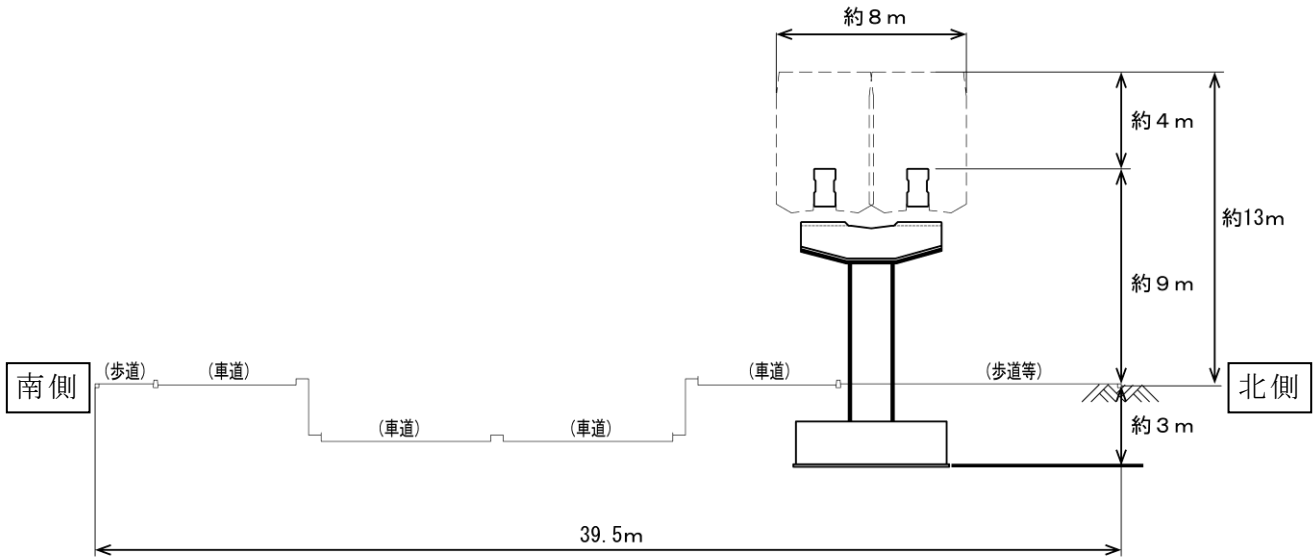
断面図 (箱根ヶ崎アンダーパス部)
